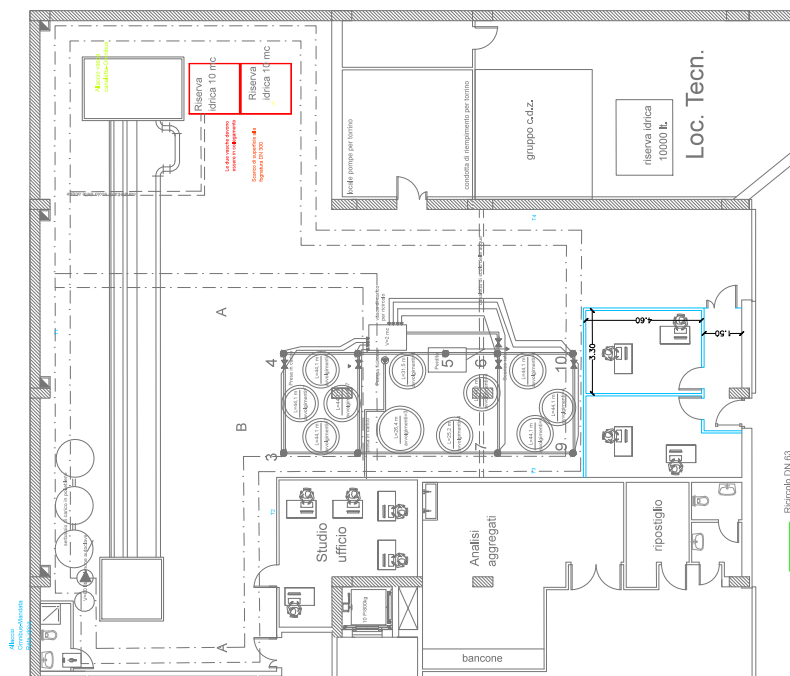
Planimetria del Laboratorio di Idraulica Ambientale.
